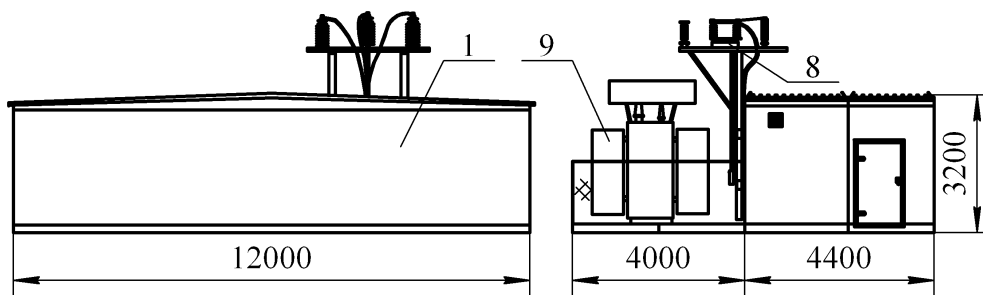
Общий вид и план расположения оборудования комплектной трансформаторной подстанции типа КТПБ-6/35-4х16000М
